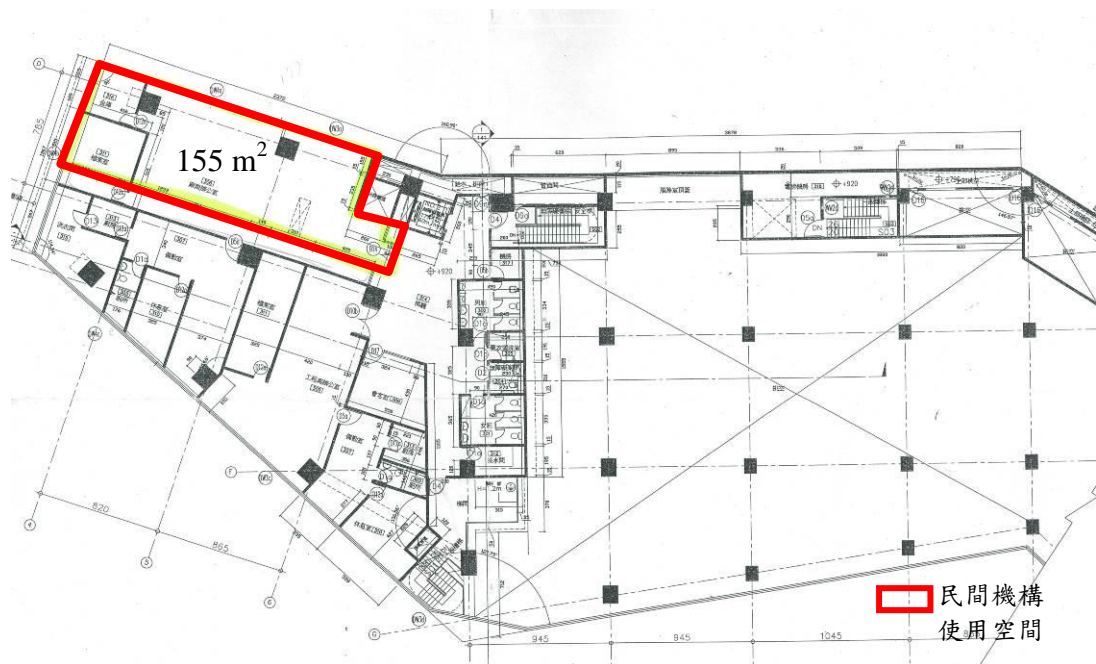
蘇澳服務區服務中心 3 樓平面圖
